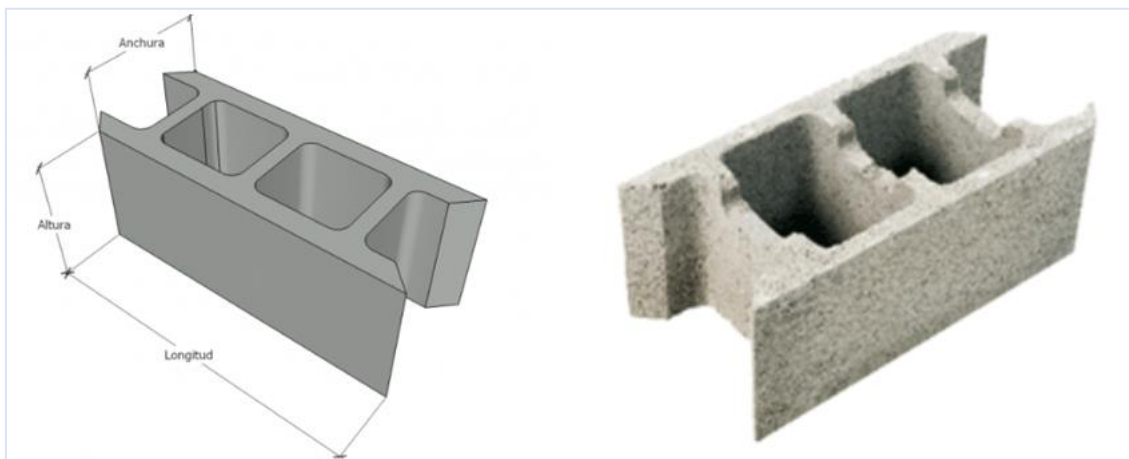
Dimensiones del bloque estructural 50*20*25 cm. Fuente: Bloqueman S.A. (<http://bloqueman.com/bloque-de-muro/12-bloque-20x25x50-gris-muro.html>).
